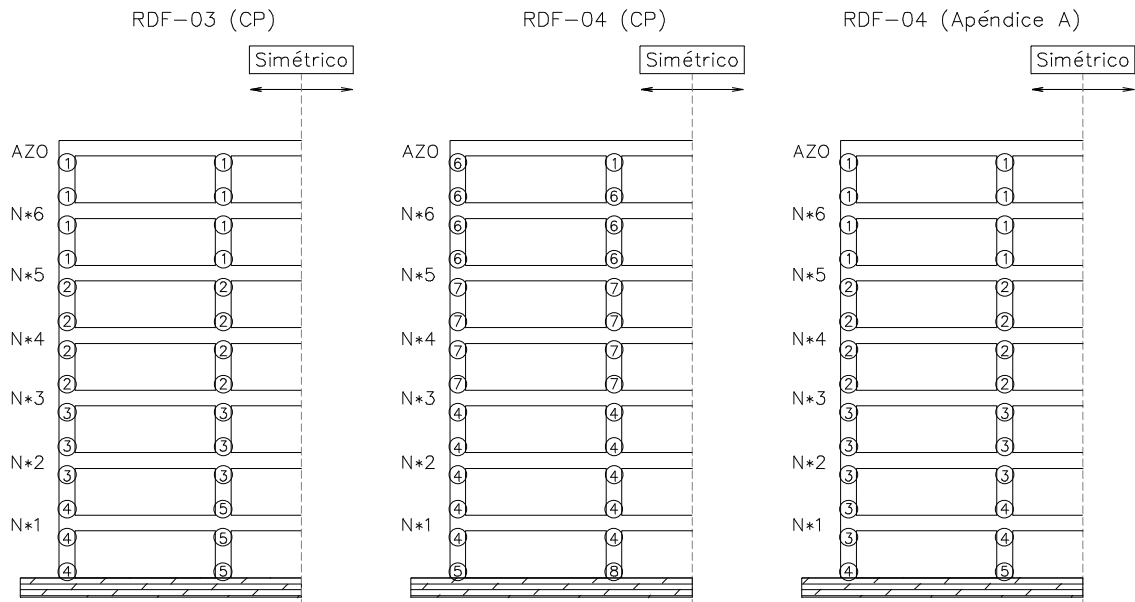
Ubicación de los tipos de armados de columnas del eje 2, estructuras de 7 niveles, diseños en zona III (RDF-93 y RDF-04)
